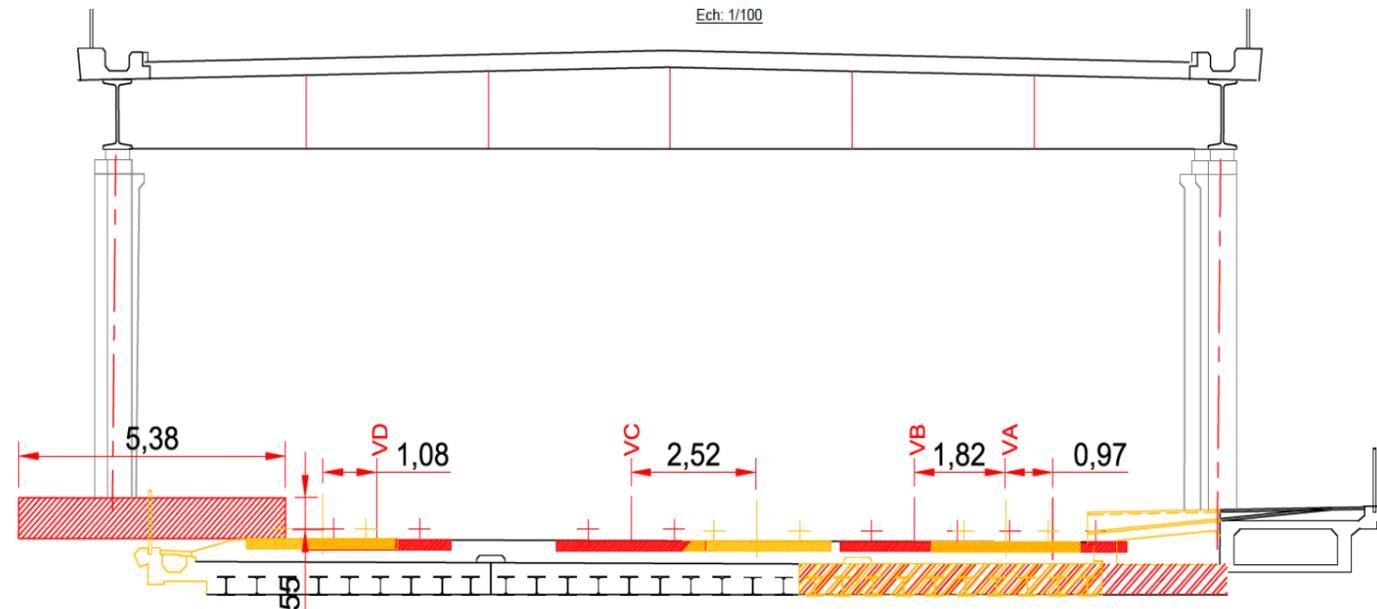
Coupe sur le pont-rail du ruisseau de la Foux (Systra, 2021)
